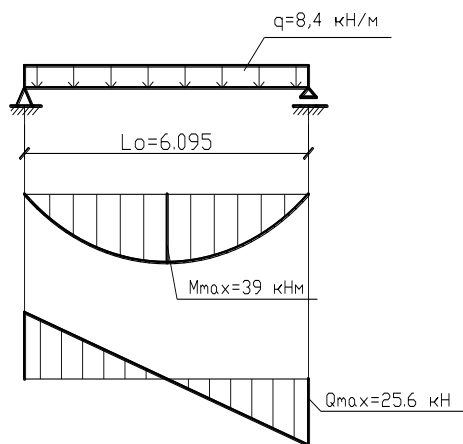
Розрахункова схема плити перекриття першого поверху будівлі
